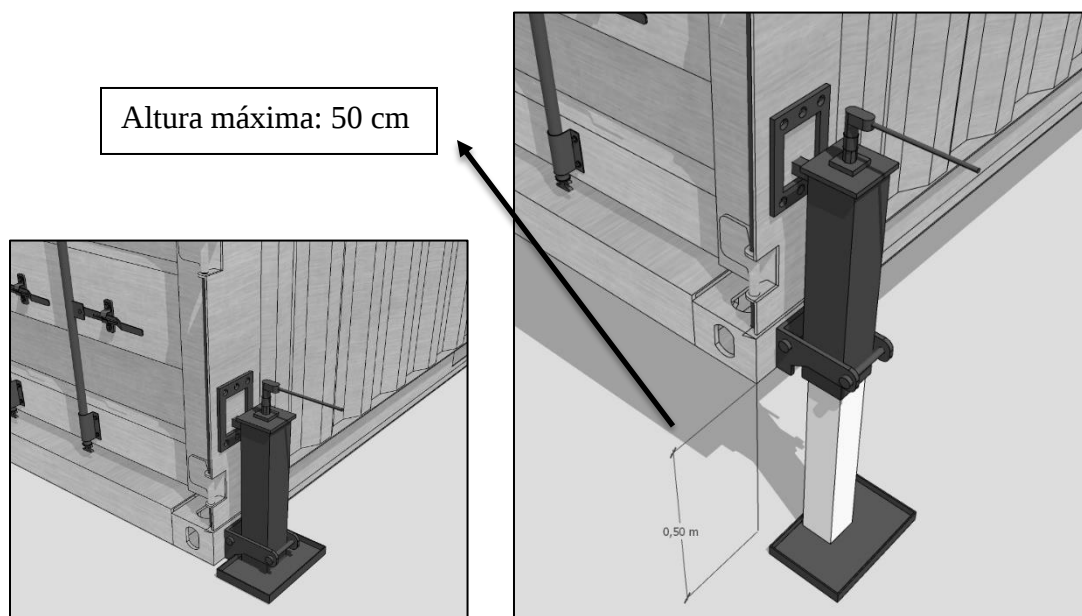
Cimentación propuesta plano de detalle y representación 3d de brazo hidráulico. Elaboración propia
